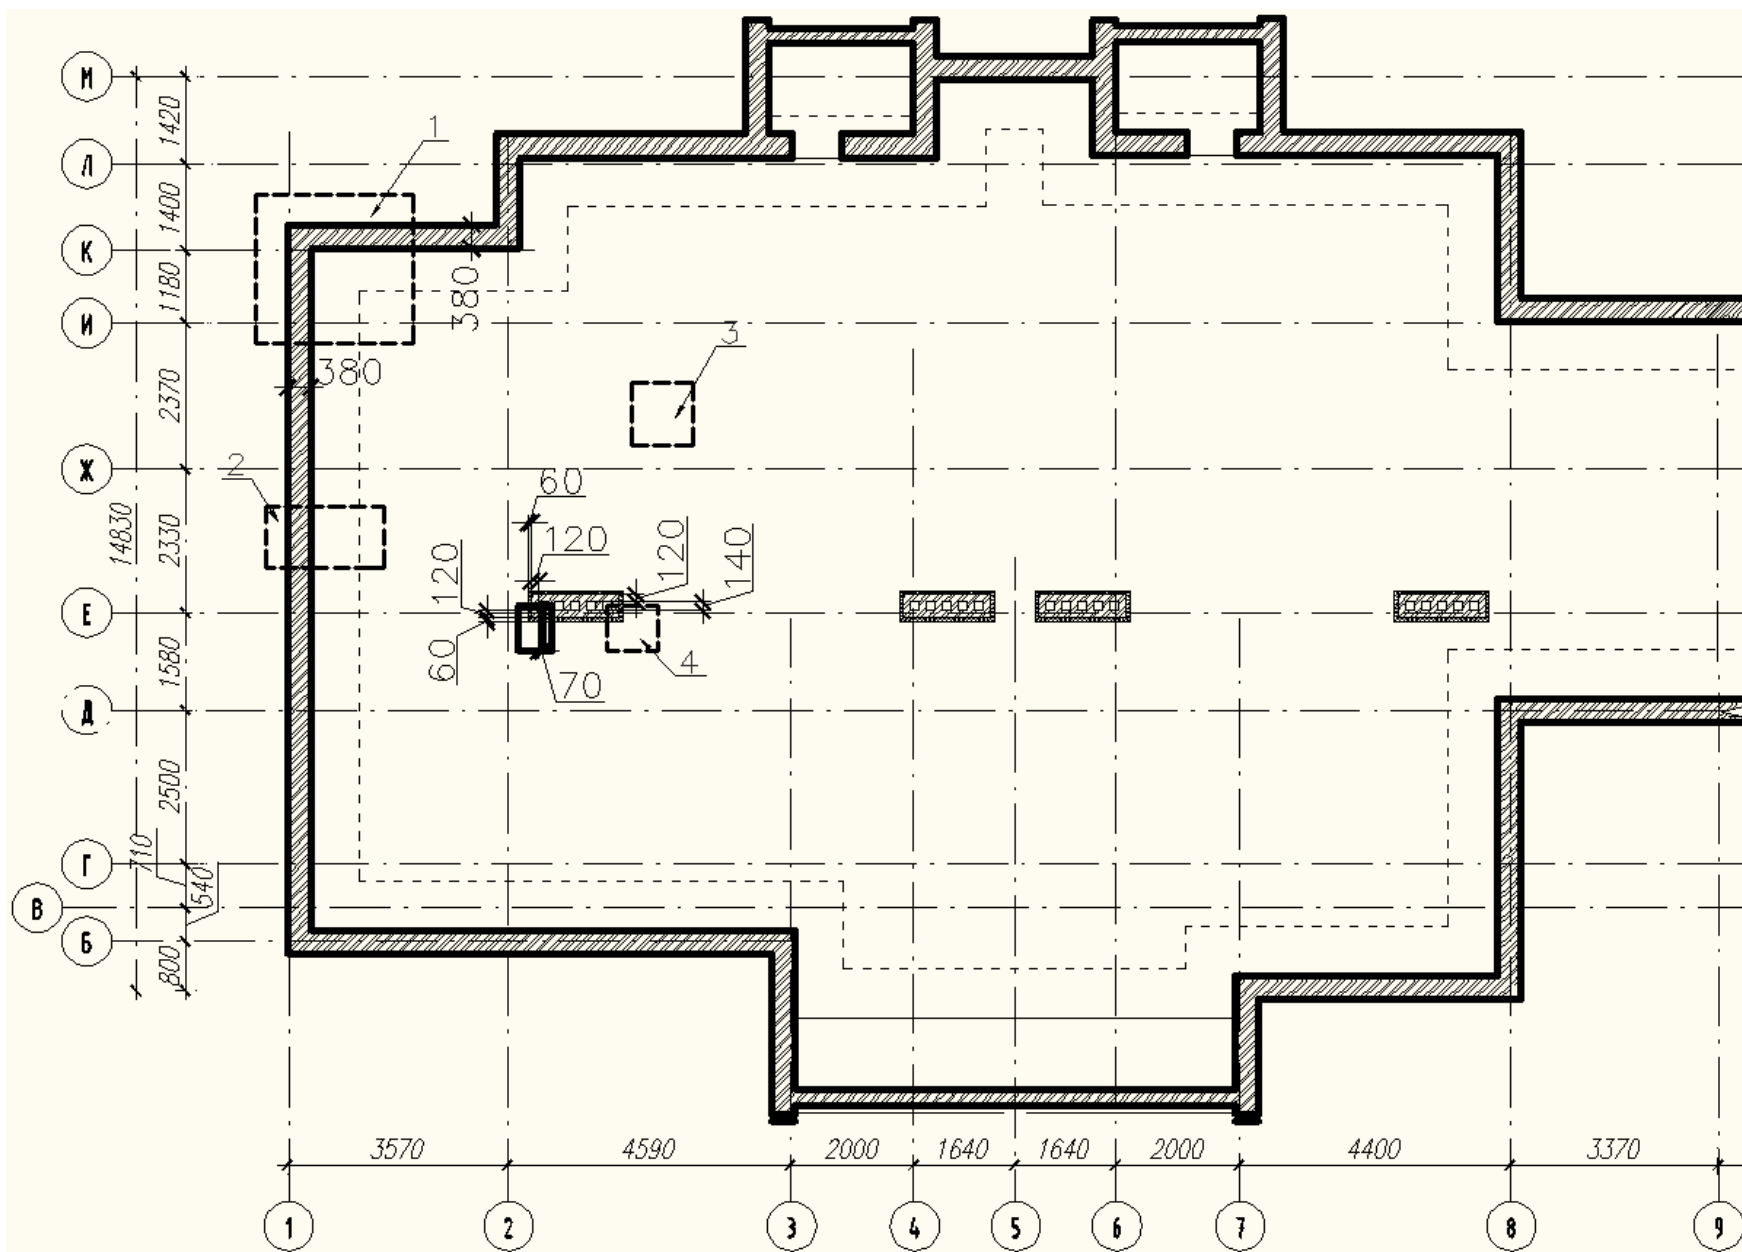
Пример разбиения наружных стен чердачного перекрытия на расчетные участки
